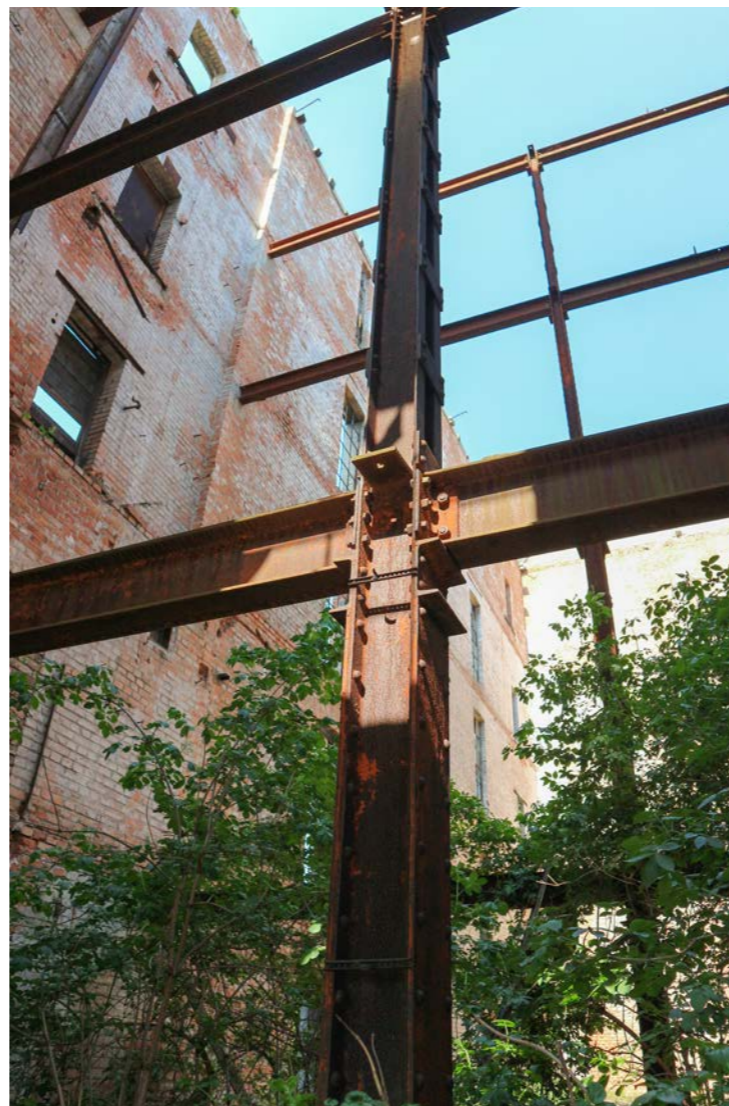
Detail der Stahlkonstruktion im Getreidesilo
